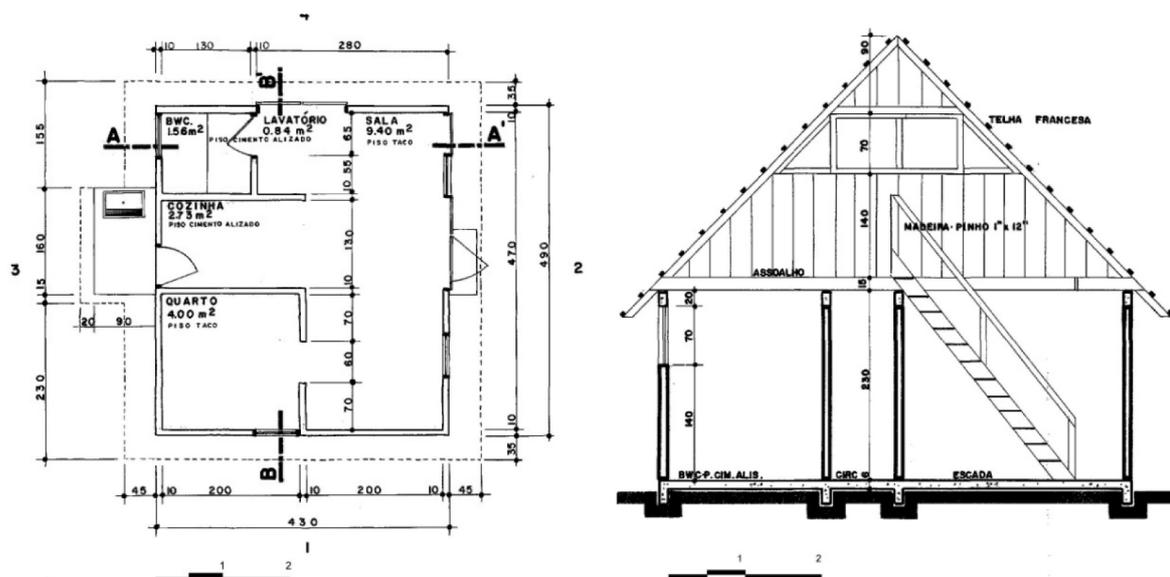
Planta e corte transversal da tipologia de casa CT-5-50, adotada para o Conjunto Habitacional Vila Nossa Senhora da Luz.
